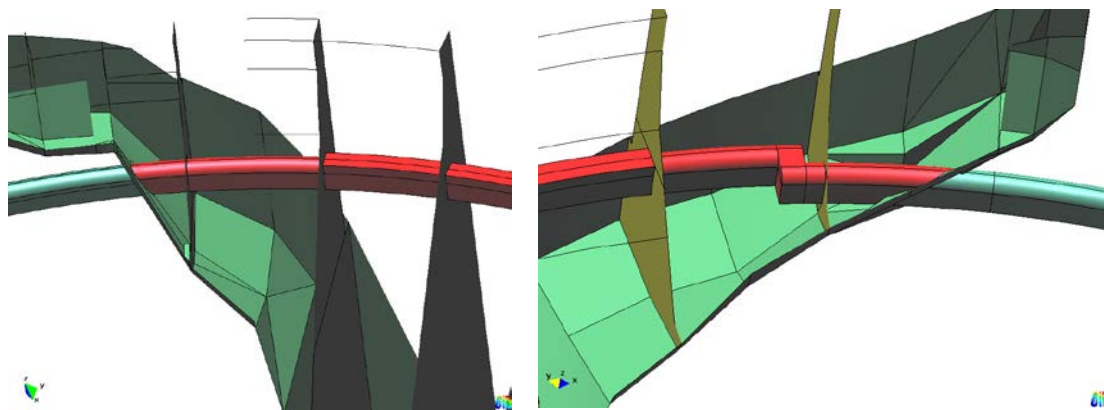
Detalle de la galería cerca del estribo derecho e izquierdo, respectivamente.
